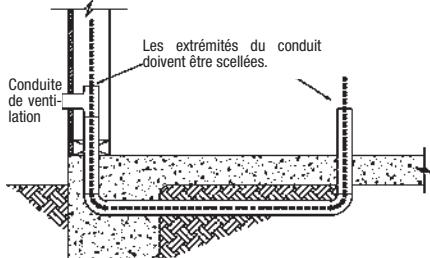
Installation dans un conduit non métallique avec ventilation
